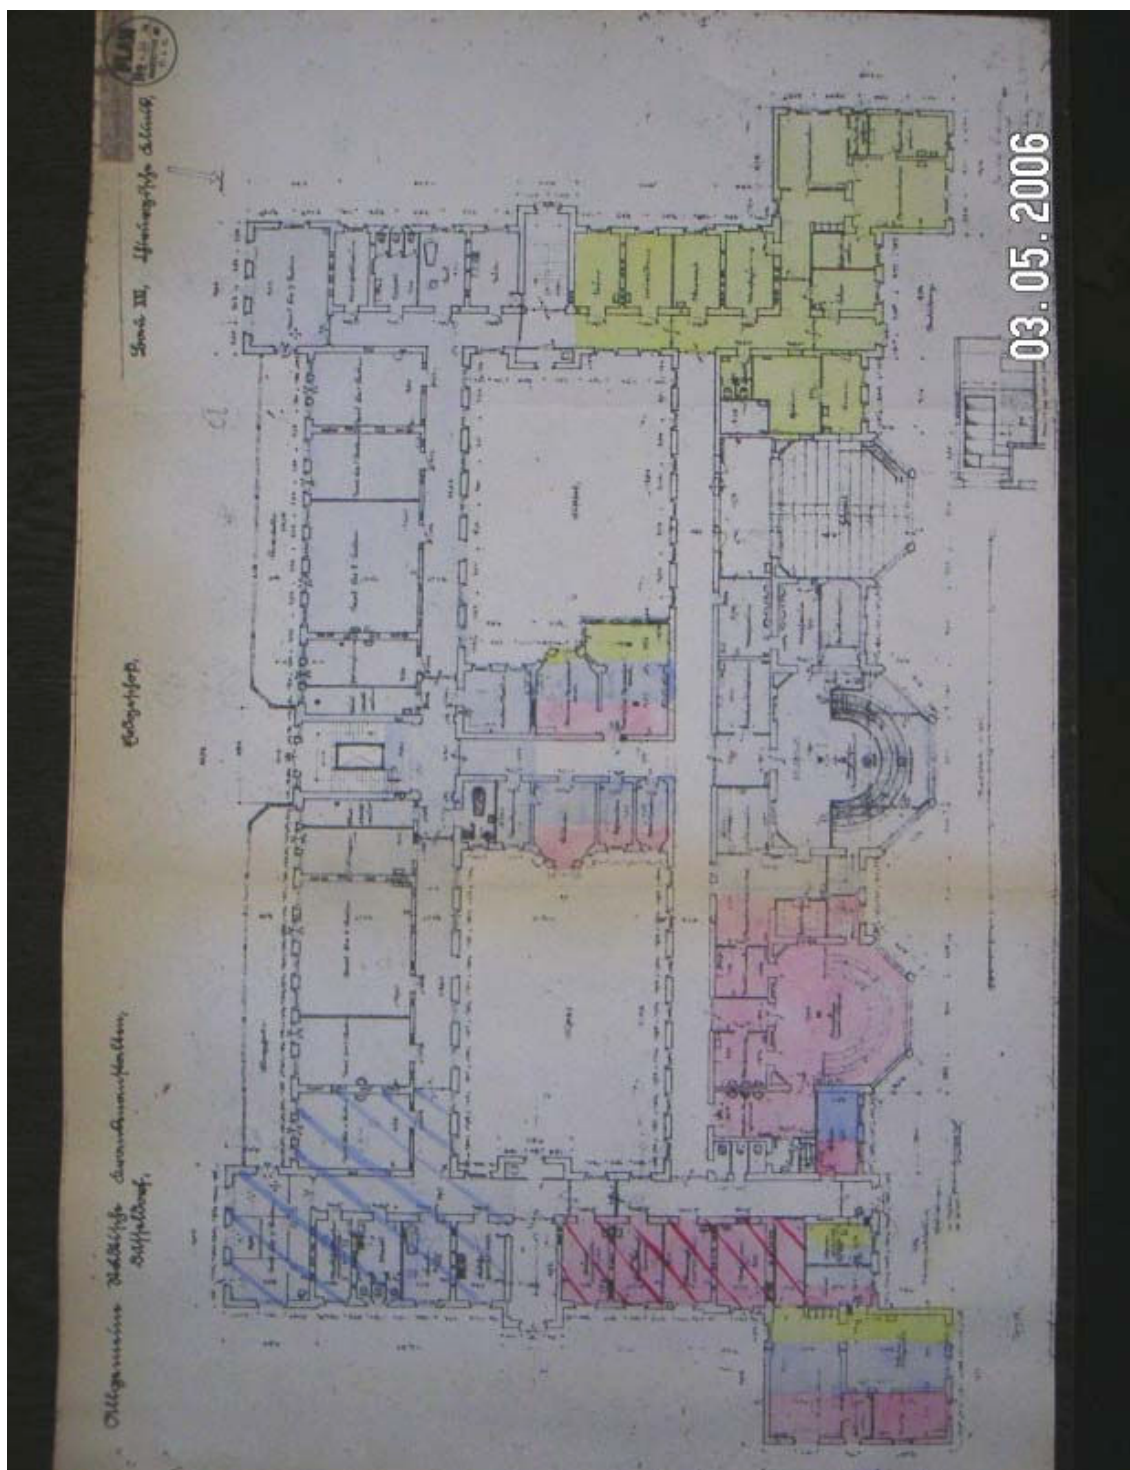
Grundriss der Urologischen Klinik; Planungsstand 1967 ²⁷⁰
